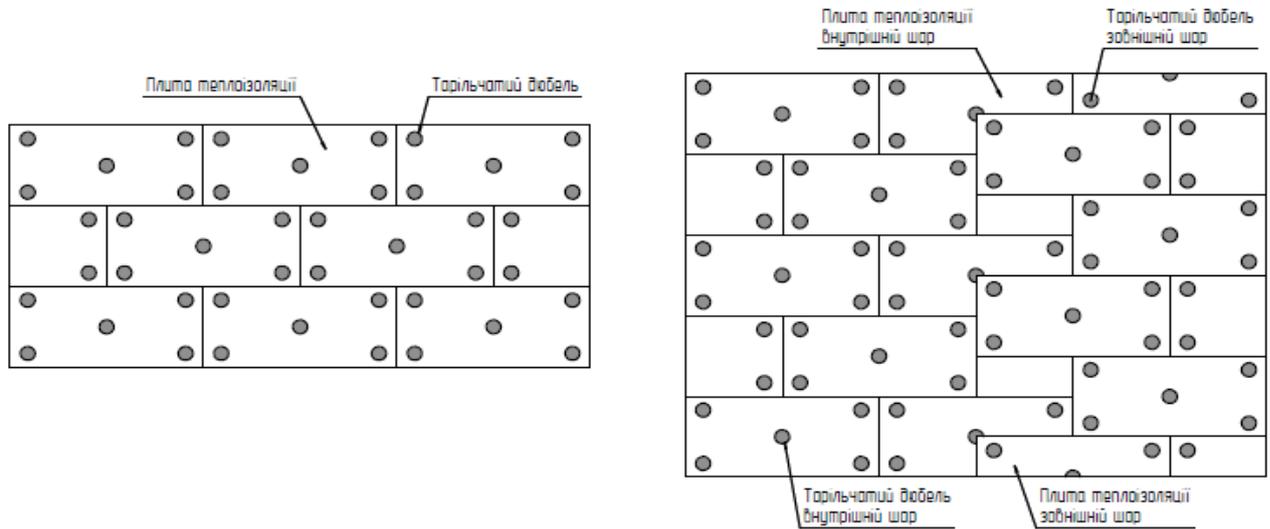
Схема установки плит для однашарового утеплення
